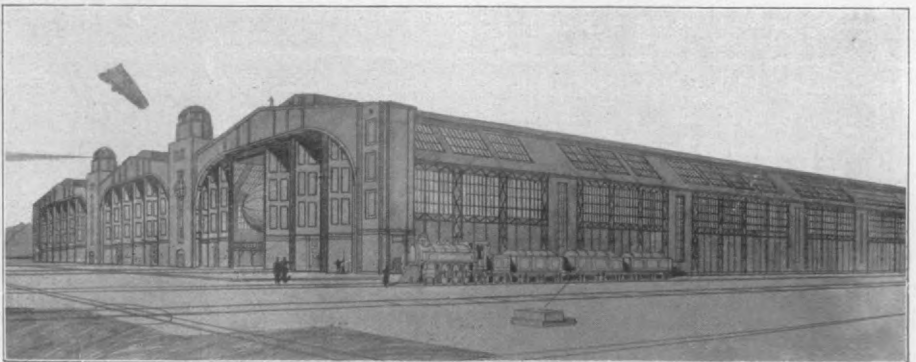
Entwurf Ing. Mälzer, Aussenansicht der Hallenbauten.
